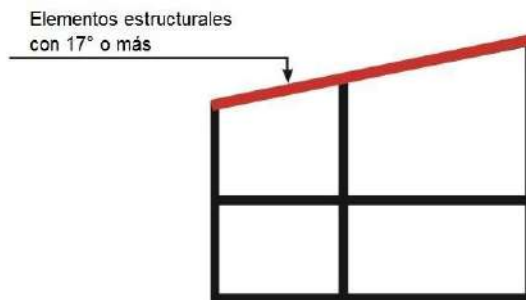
Elemento estructural con alto nivel de inclinación
